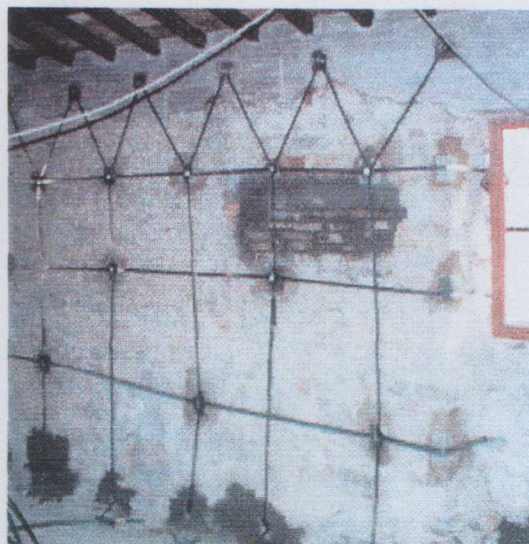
disposizione delle maglie su parete con intonaco completamente rimosso.
